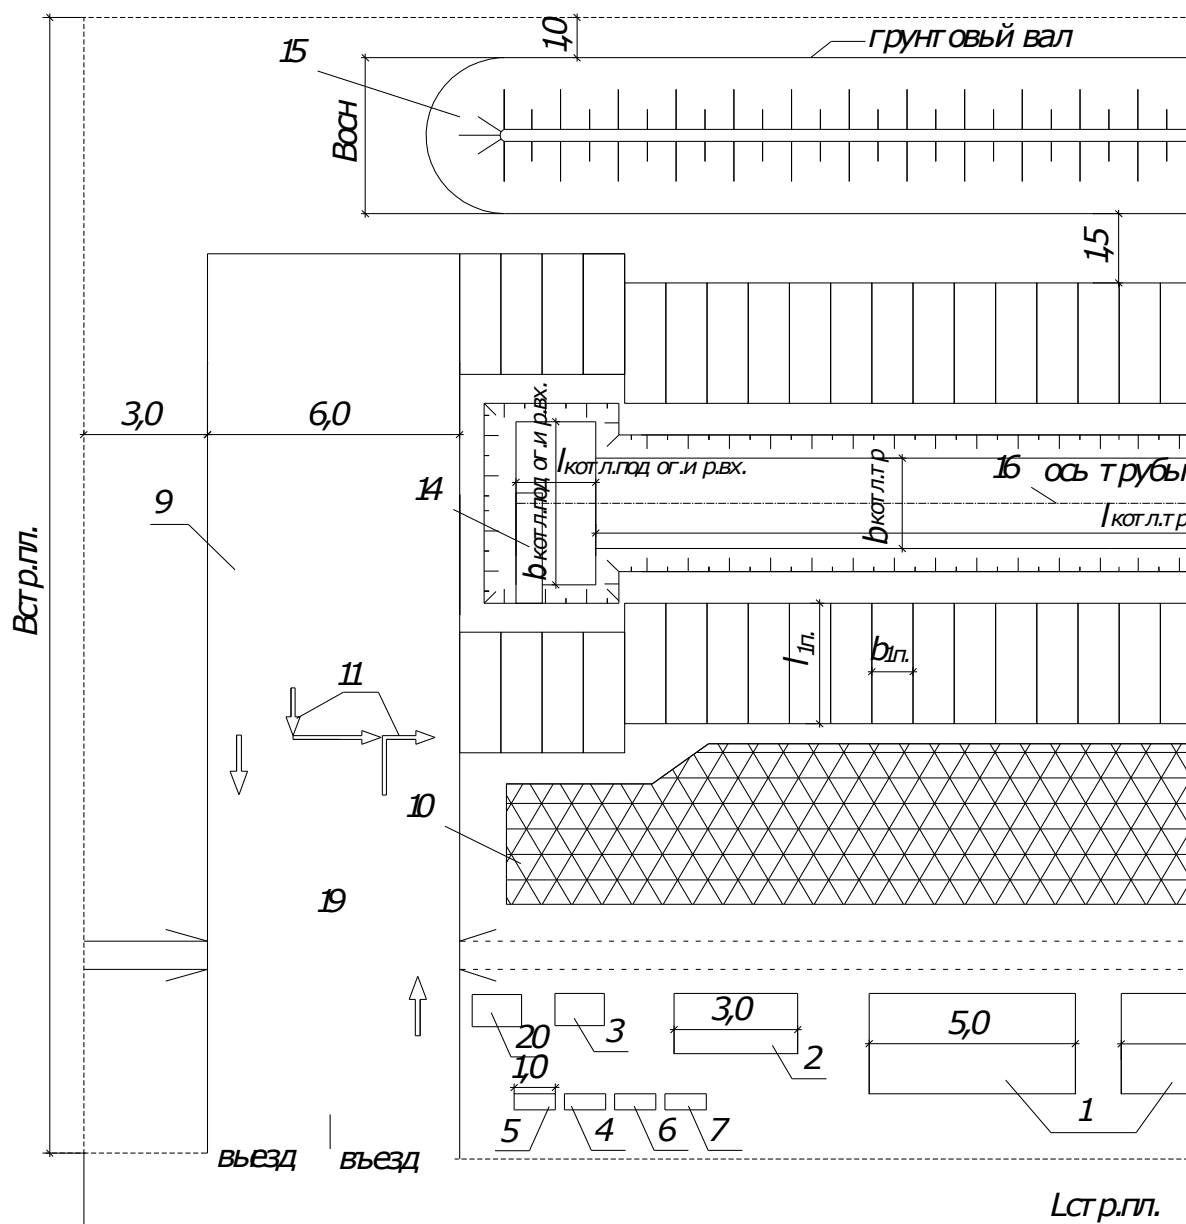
Схема организации строительной площадки водопропускной трубы:
